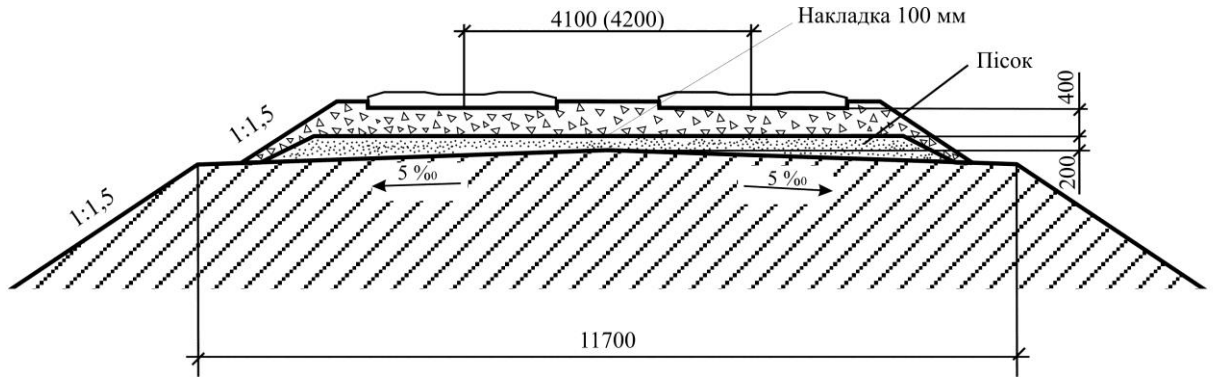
Конструкція земляного полотна із піщаним шаром
